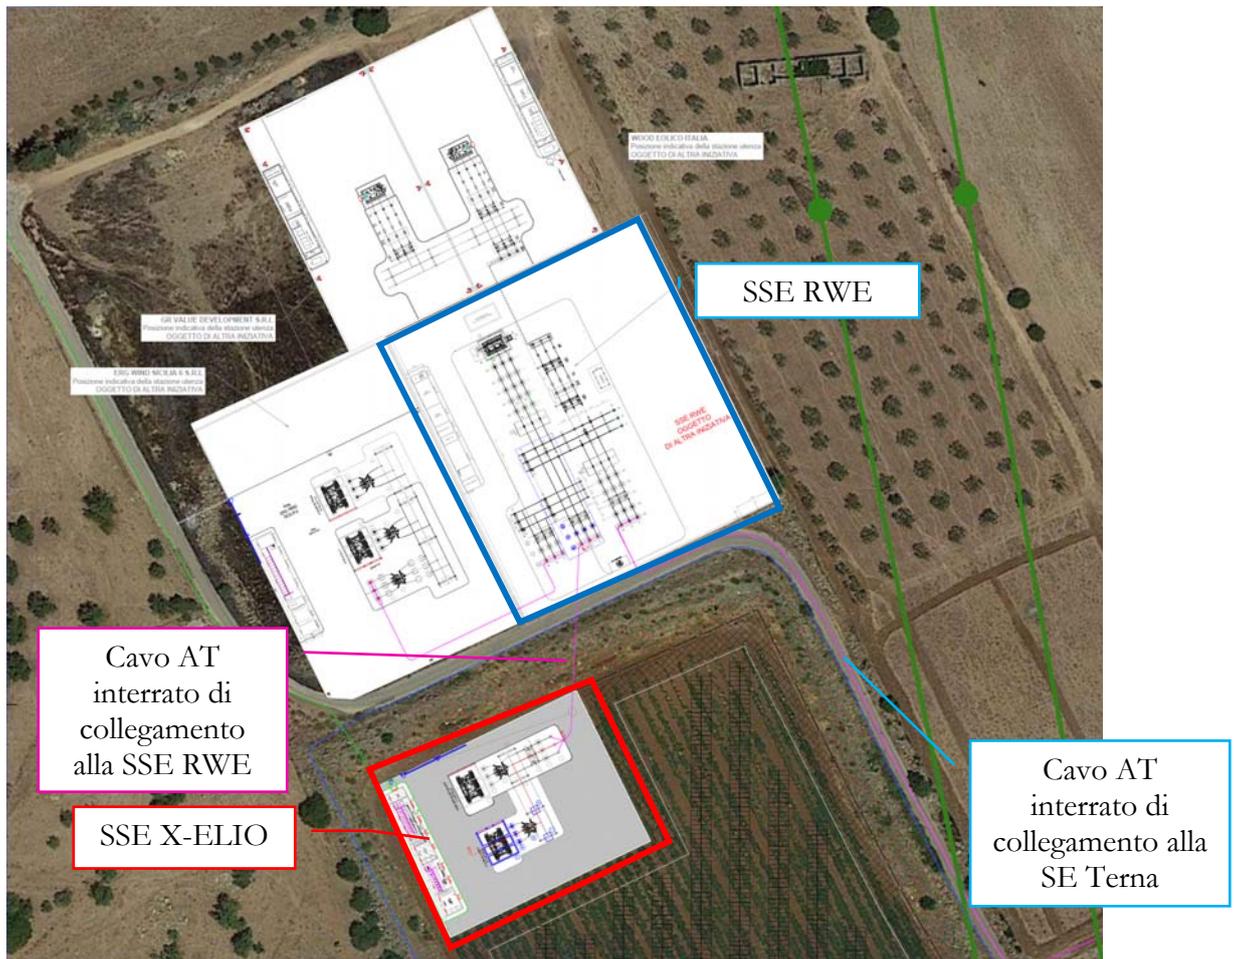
Planimetria con individuazione nuova SSE ed elettrodotto di collegamento alla SE Terna esistente
